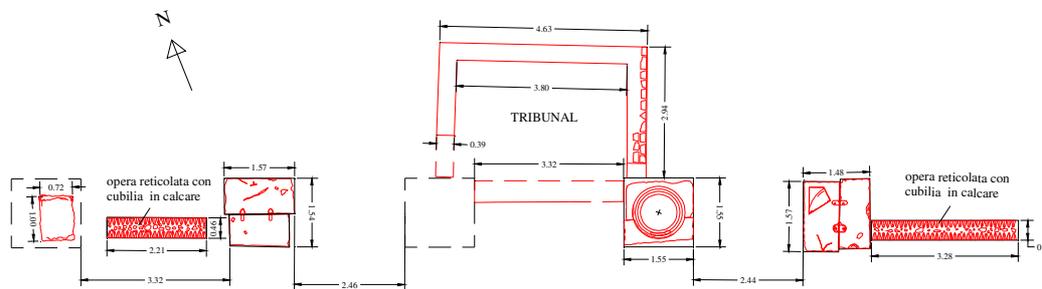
colonnato sud, pianta di Alessandra Iodice.
